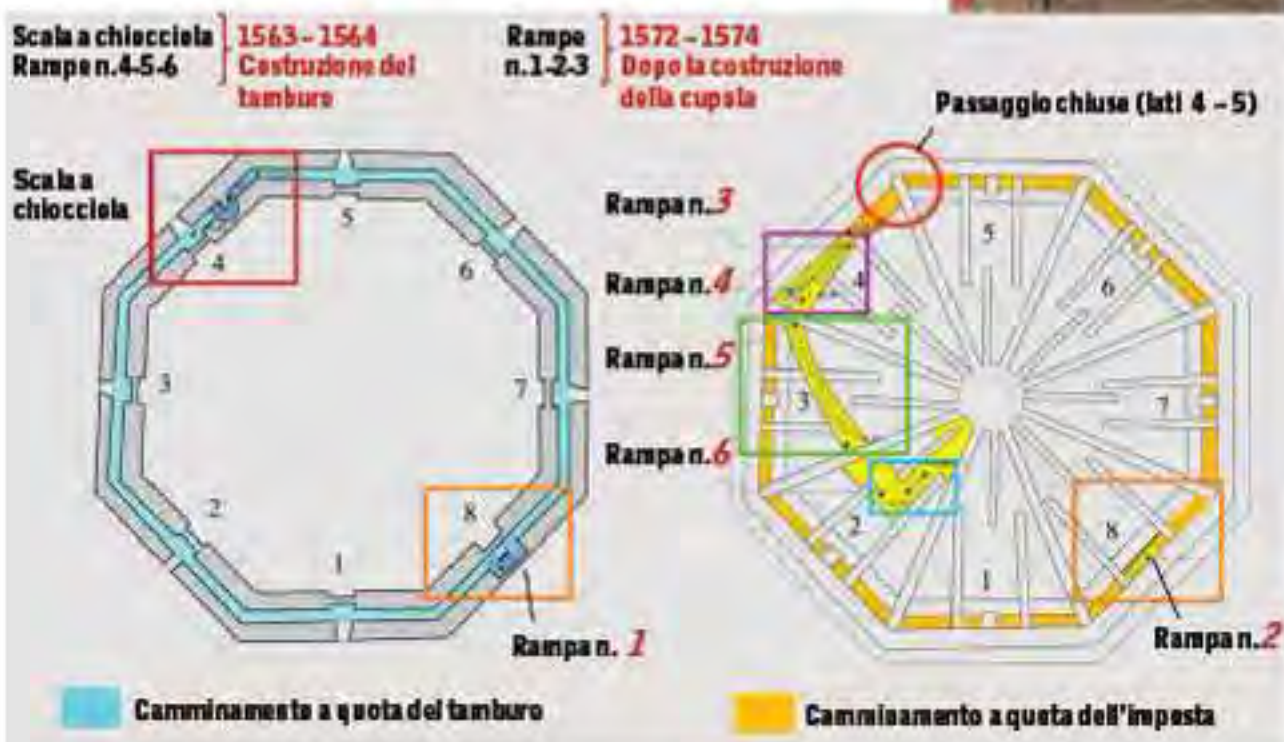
Stato attuale dei collegamenti verticali. A sinistra, lo schema planimetrico del tamburo e a destra, lo schema planimetrico della cupola
